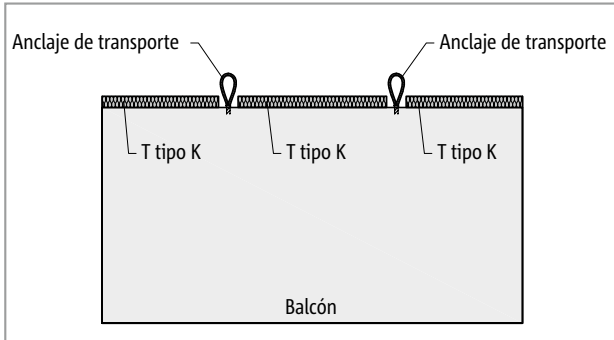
Schöck Isokorb® T tipo K: Balcón de elementos con anclaje de transporte; en obra se puede colocar el adaptador aislante T tipo Z
